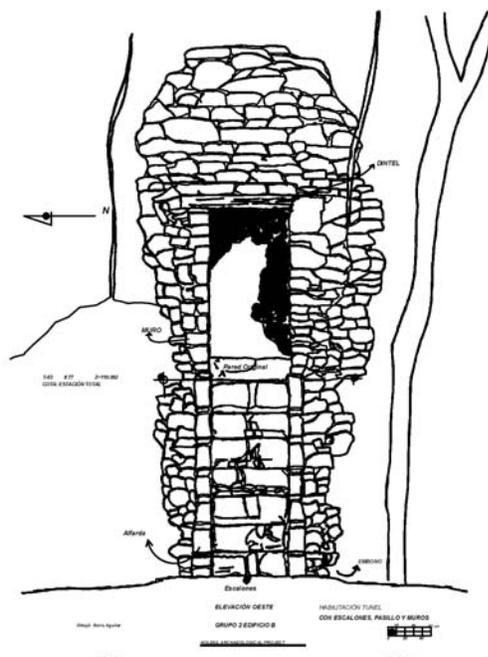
Perfil de escalinata y tunnel de acceso desde nivel de plaza a la fachada oeste a Edificio B, fase I
